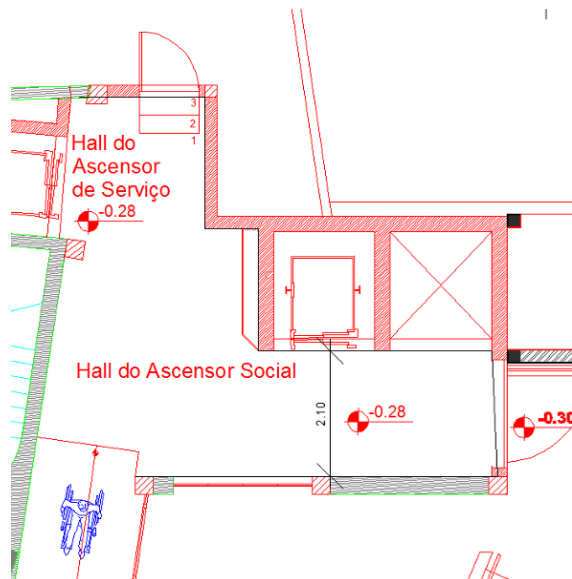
Planta piso -1 - proposta inicial na zona da torre do elevador [AtelierB2, 2019]
